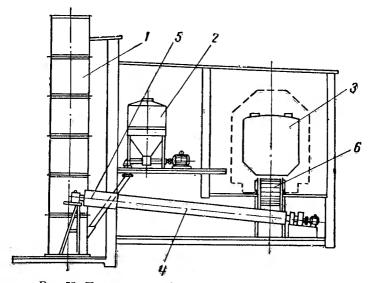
Приемное устройство типовых складов цемента 1 — элеватор; 2 — пневматический разгрузчик; 3 — вагон-цементовоз; 4 — шнек; 5 — просеивающая секция шнека; 6 — приемный рукав 61
